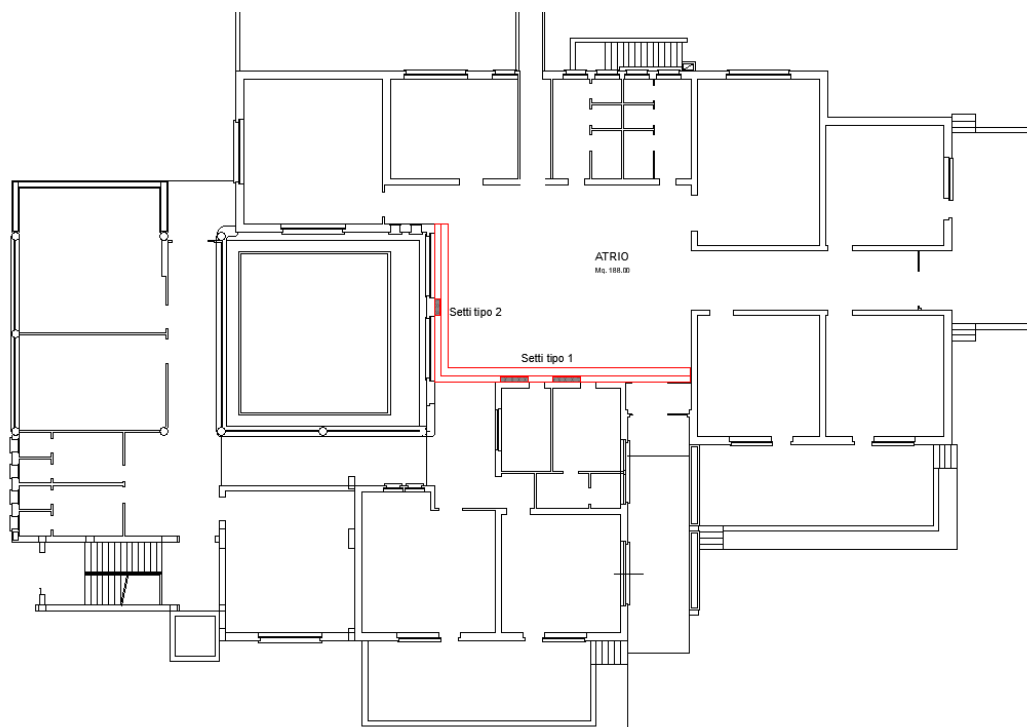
Localizzazione planimetrica nuove fondazioni.
